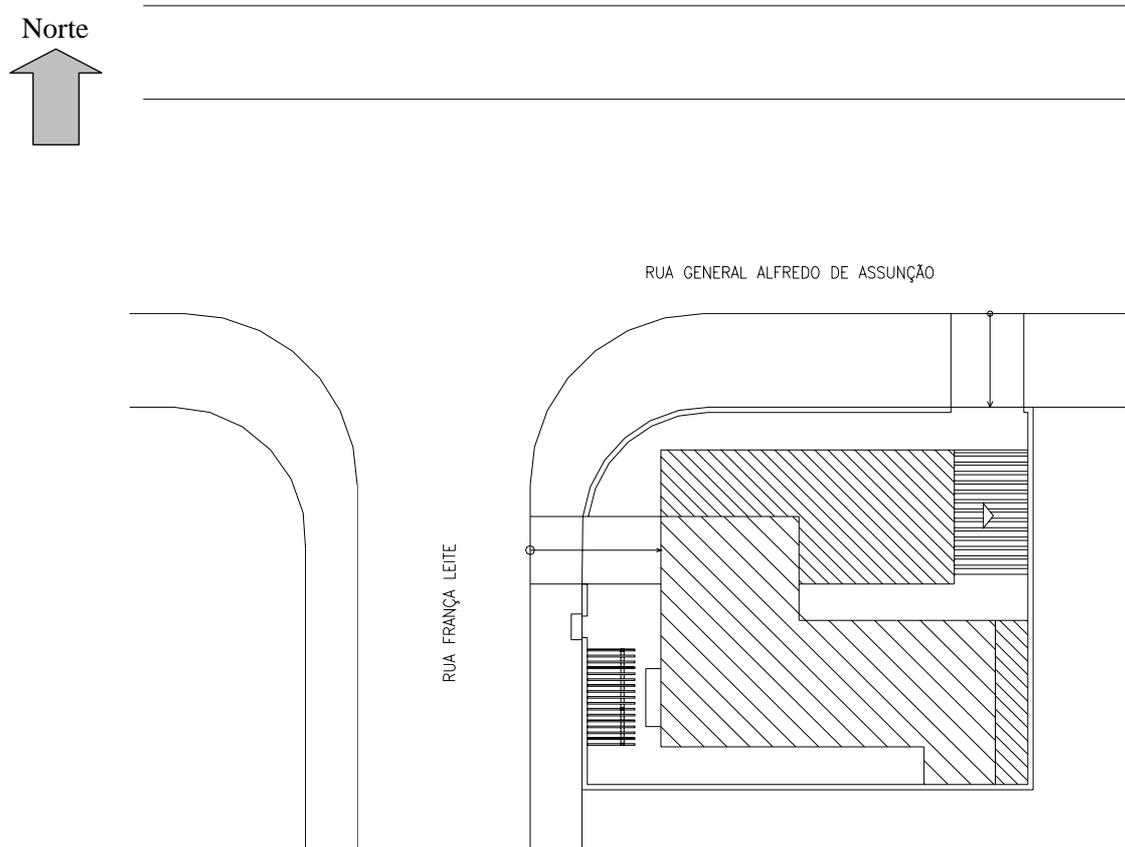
Ilustração da Planta de Situação e de Cobertura, do PSF. Fonte: CIESZO.
